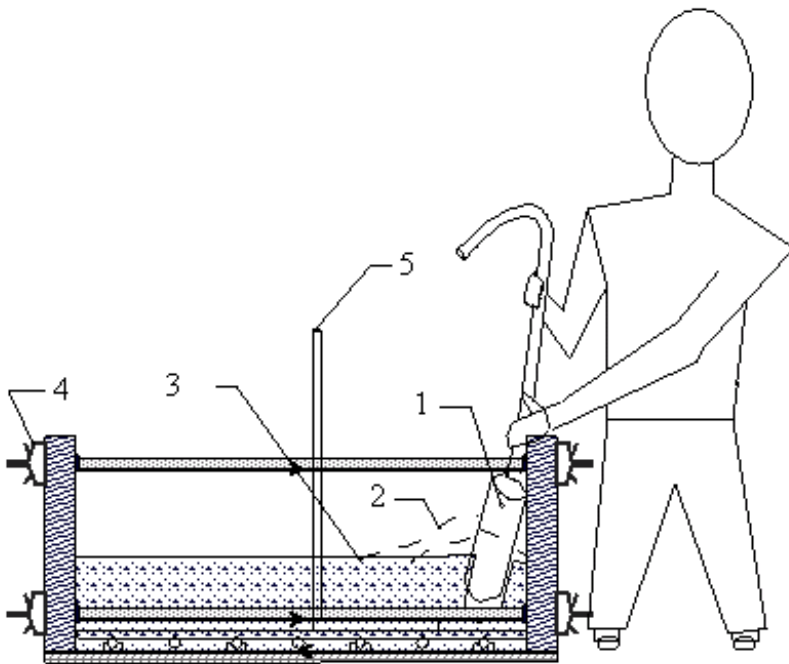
Уплотнение бетона: 1 – глубинный вибратор; 2 – бетон до уплотнения; 3 – уплотненный бетон; 4 – гайка на анкерном стержне; 5 – выпуск арматуры
